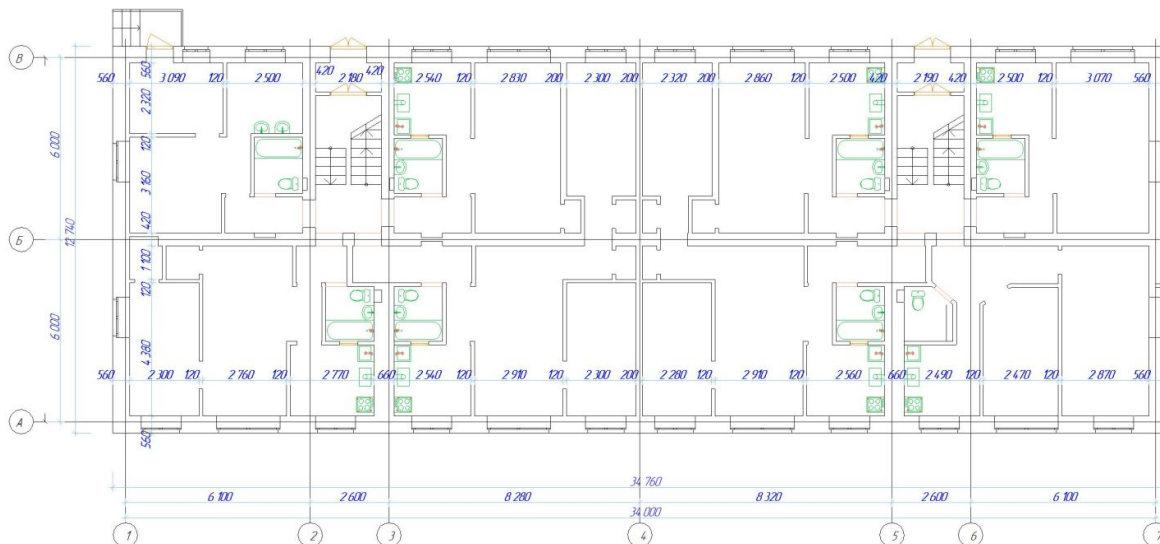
Размещение помещений и оборудования водоснабжения в здании жилого дома
